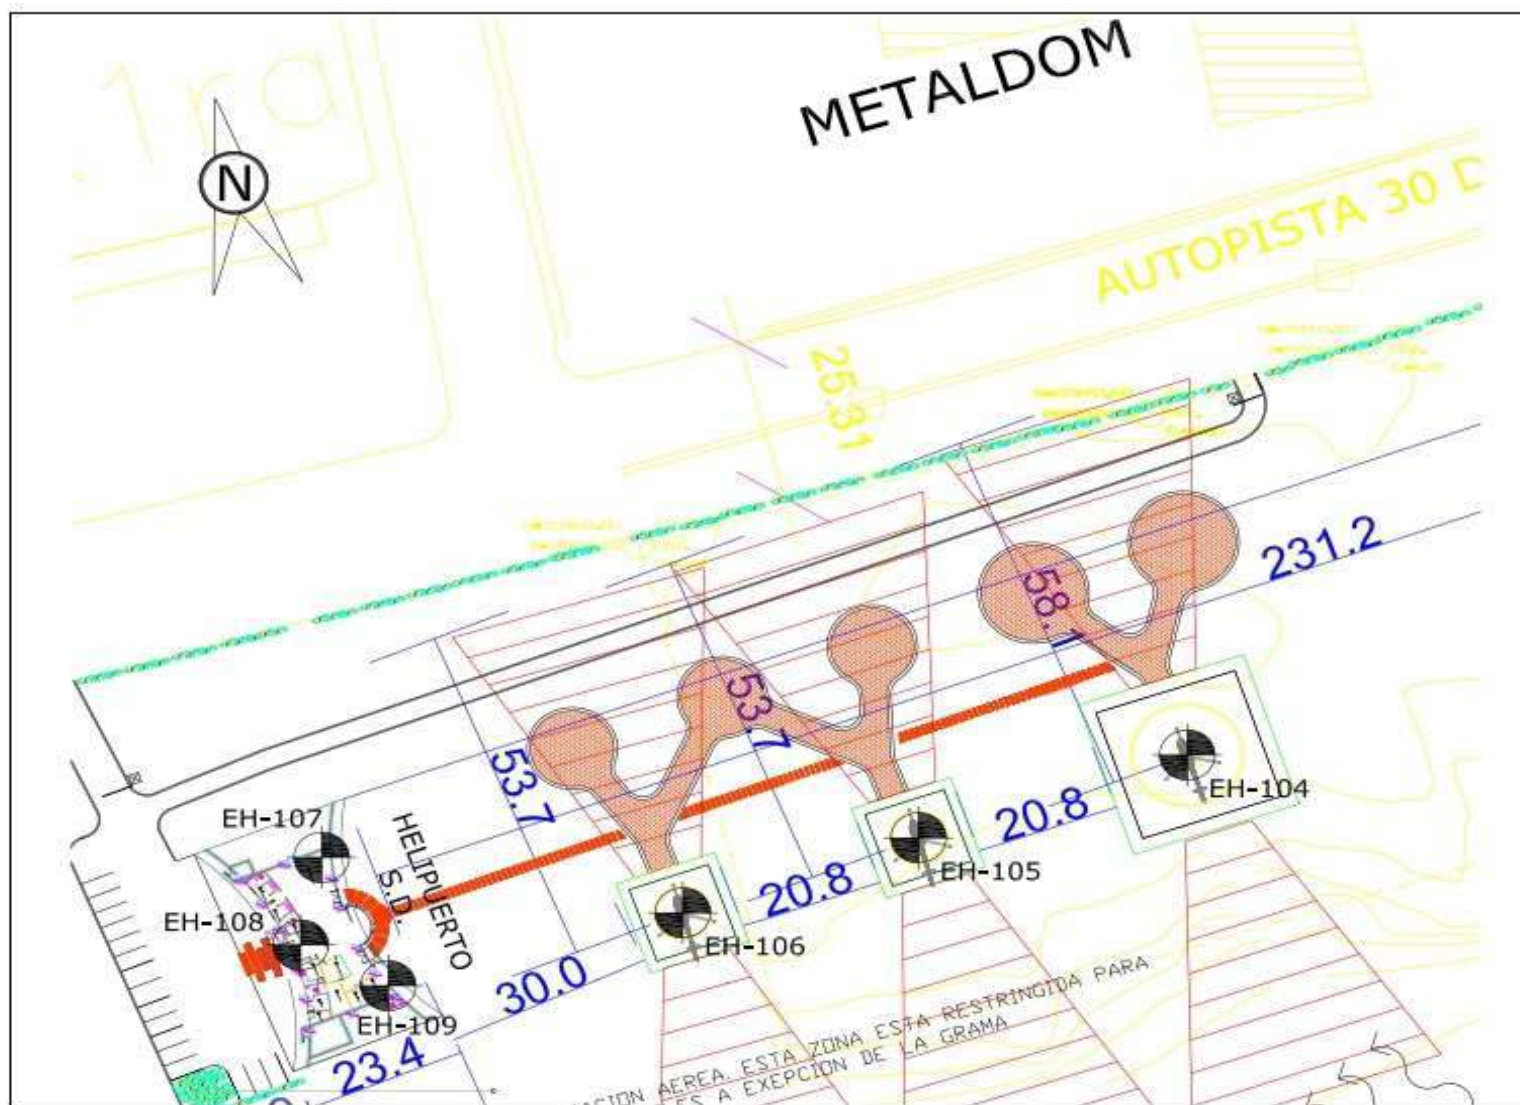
Planta de Sondeos- Helipuerto de Santo Domingo (Propuesta de construcción actual- Sondeos adicionales.
